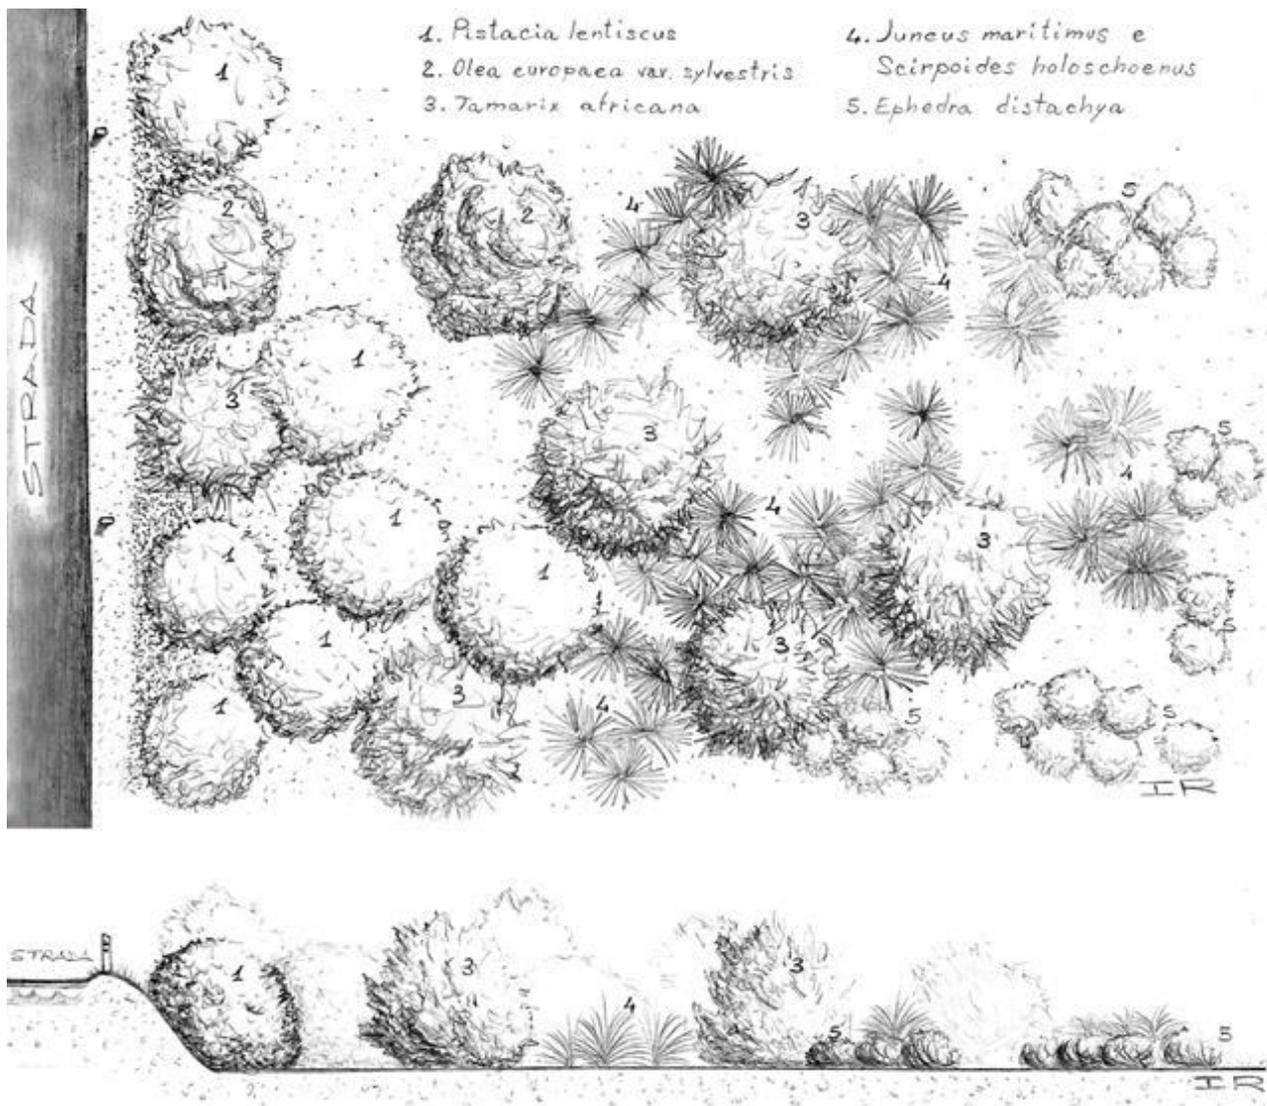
Schema generale di un nucleo di diffusione (pianta e sezione tipo).
